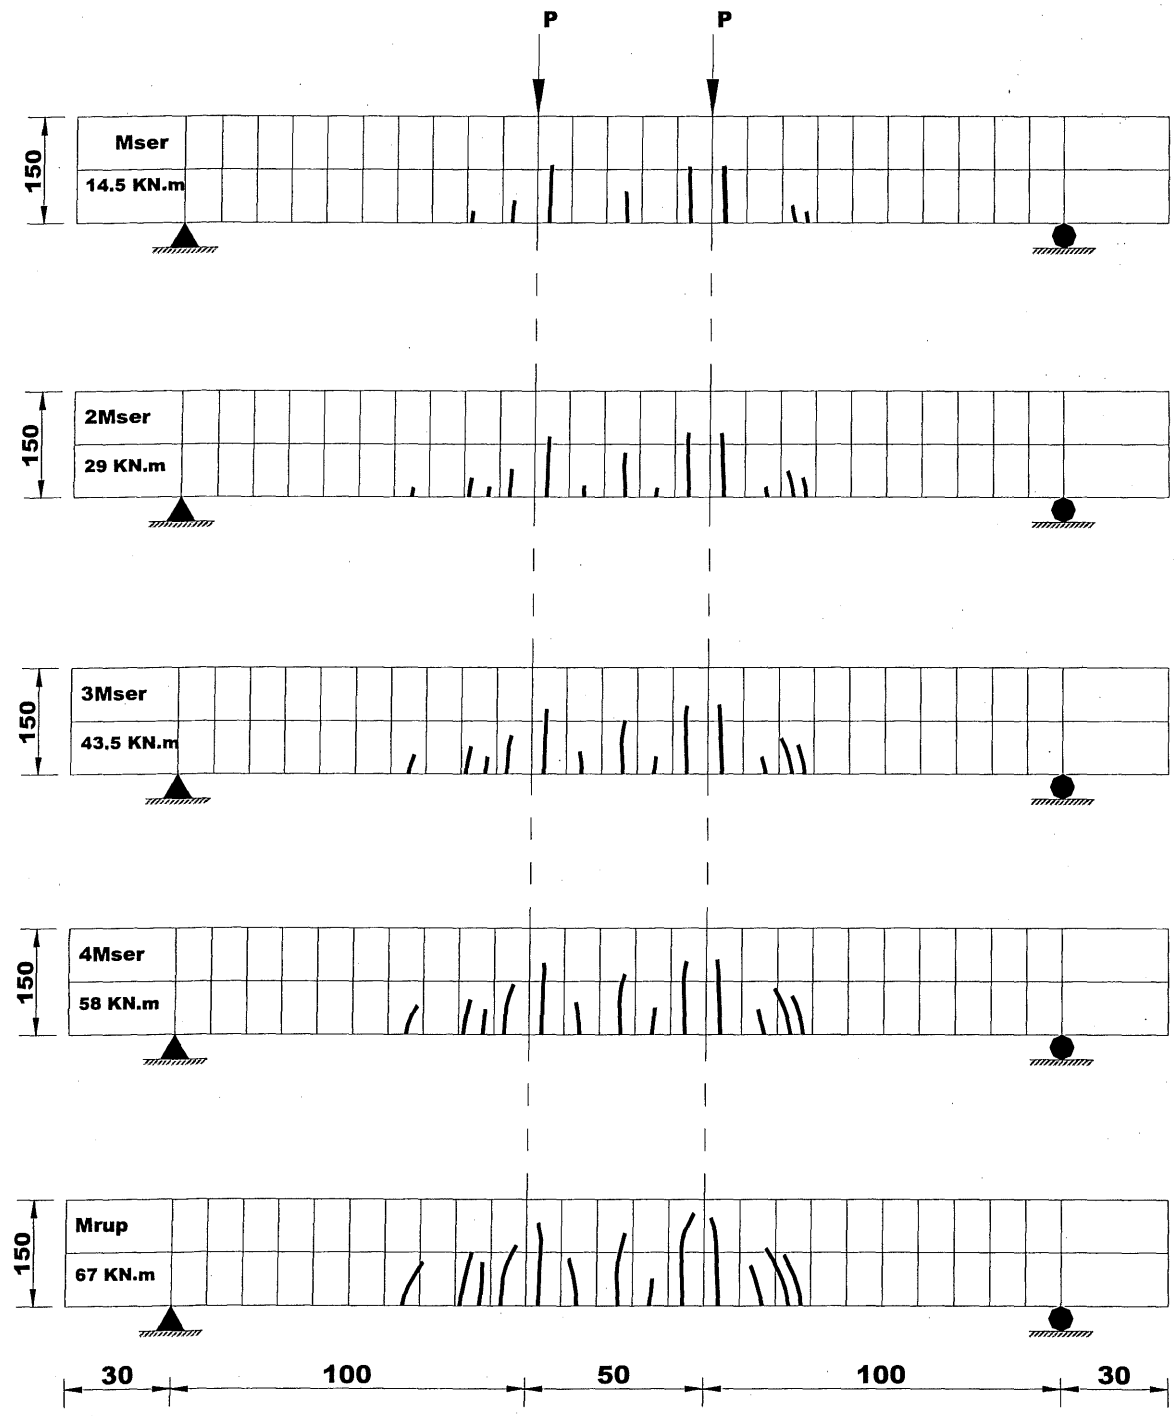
Propagation des fissures au niveau dalle S-CCN
